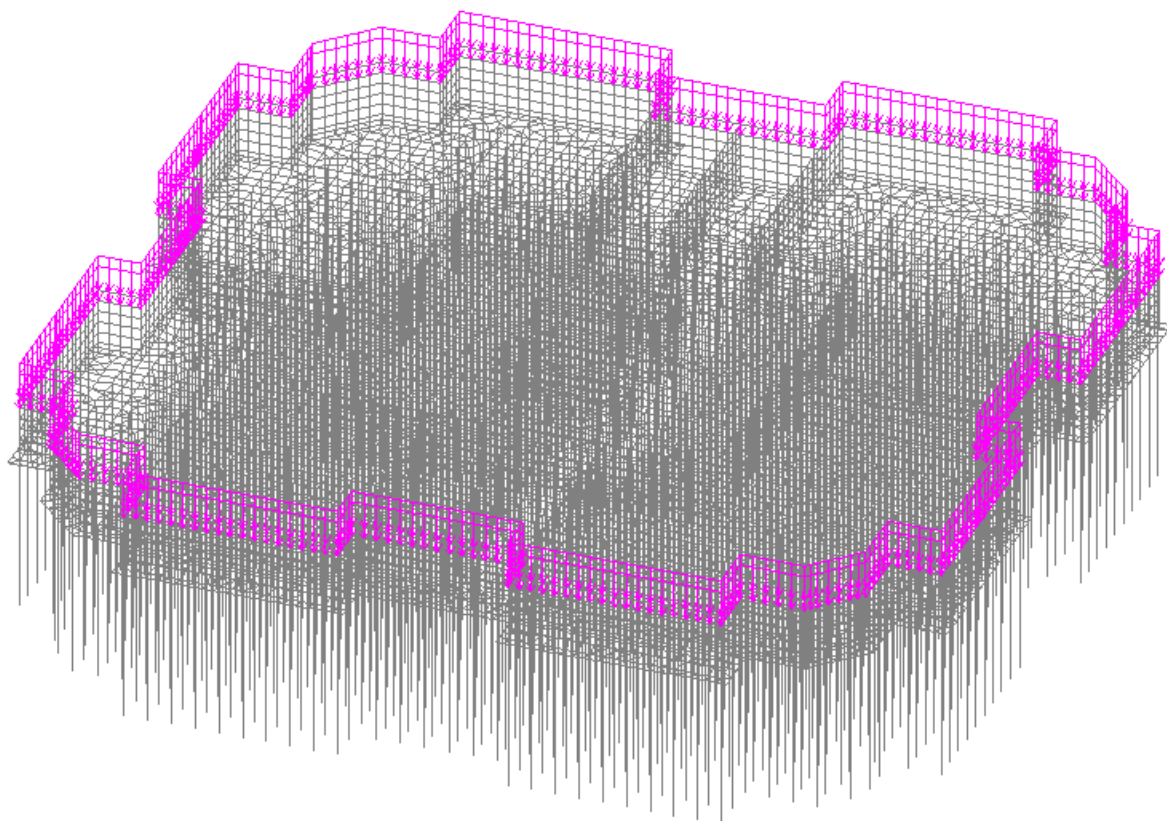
Схема приложения нагрузки на внешние стены
